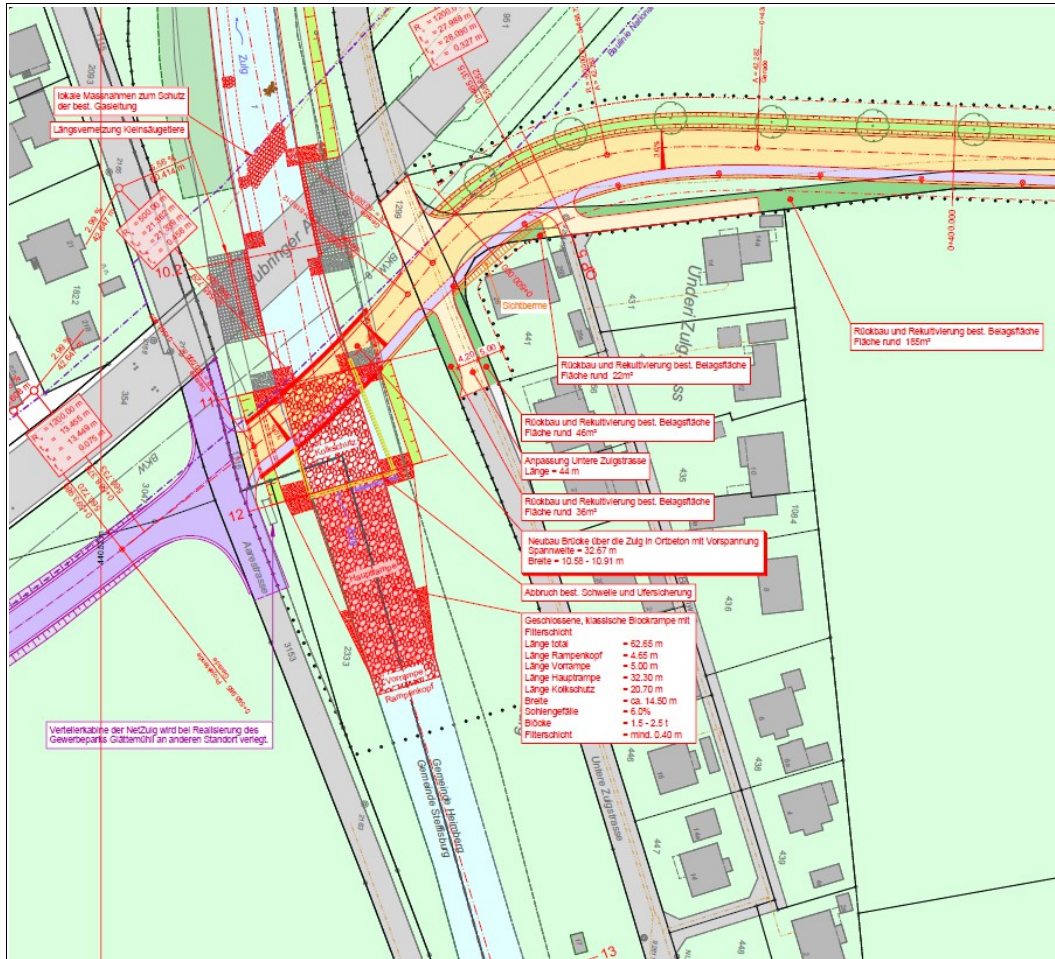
Ausschnitt Situationsplan, ohne Mst.
